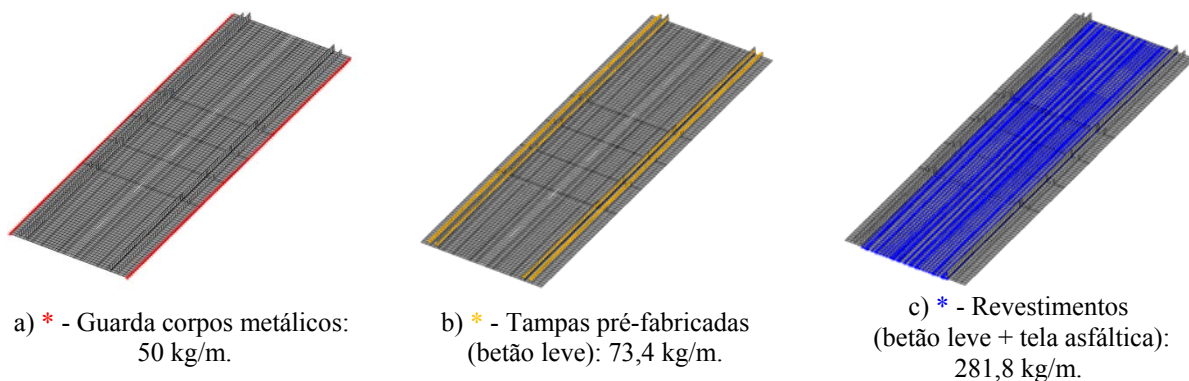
Elementos não estruturais modelados através de massas pontuais.
